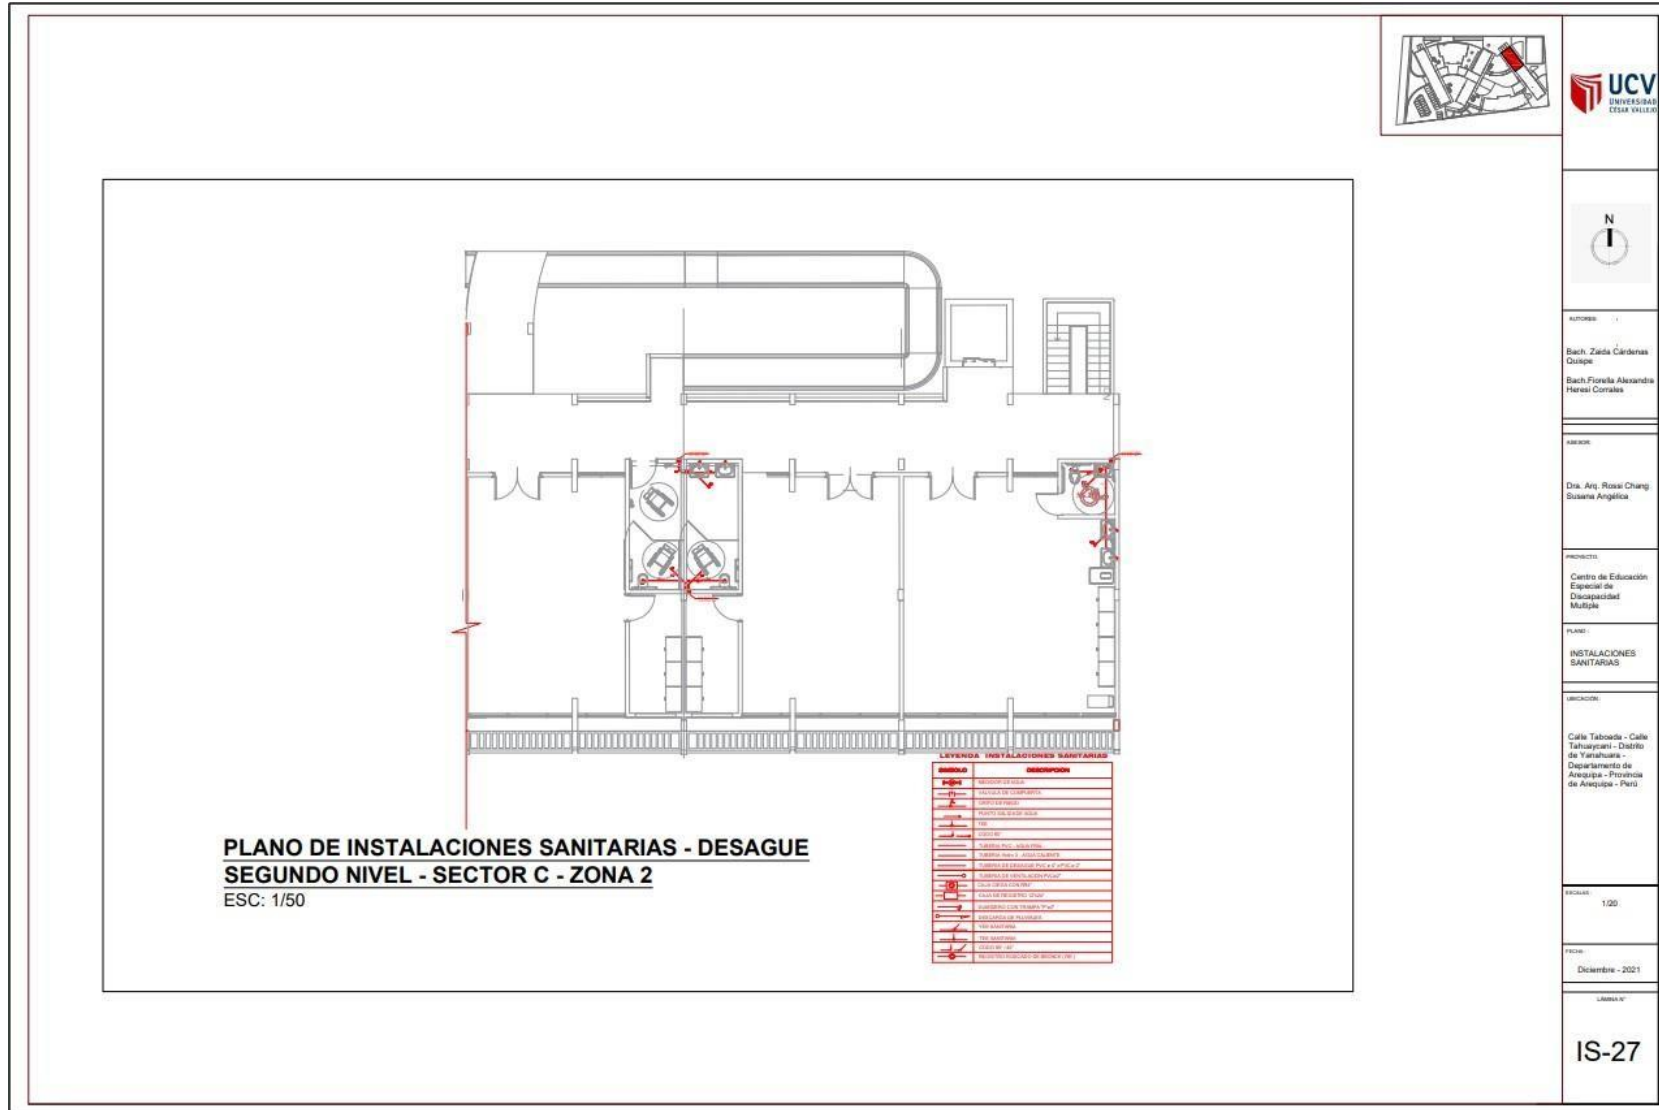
Plano de Instalaciones Desagüe – Segundo Nivel - Sector C- Zona 2
